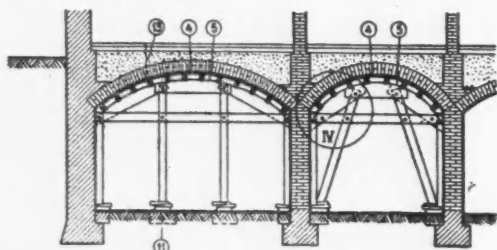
DETAIL V. — ETAYEMENT PROVISOIRE DE PLANCHES DE BOIS
